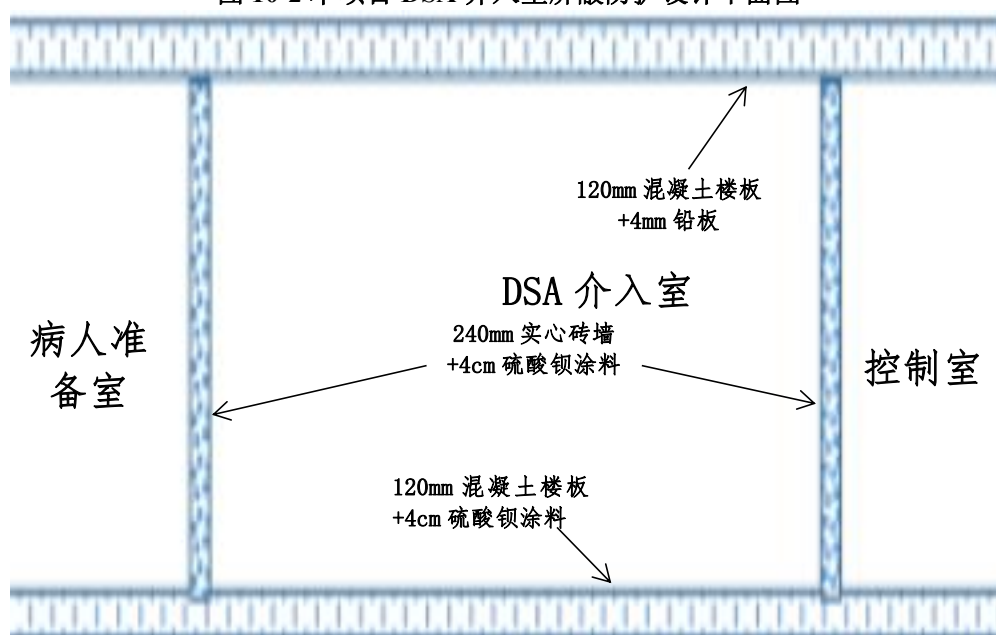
本项目 DSA 介入室屏蔽防护设计剖面图
